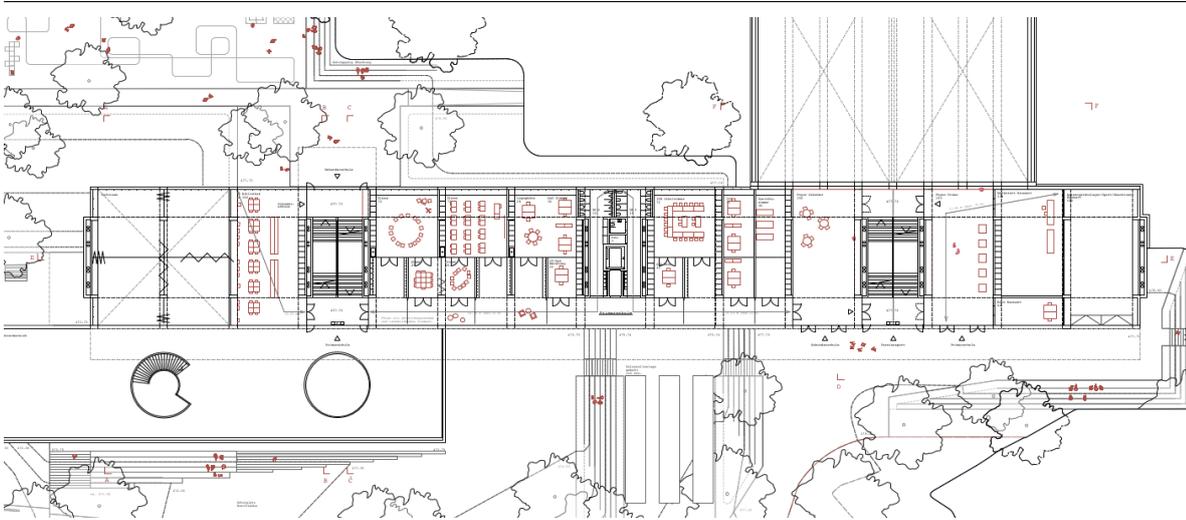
Grundriss 1. Obergeschoss
